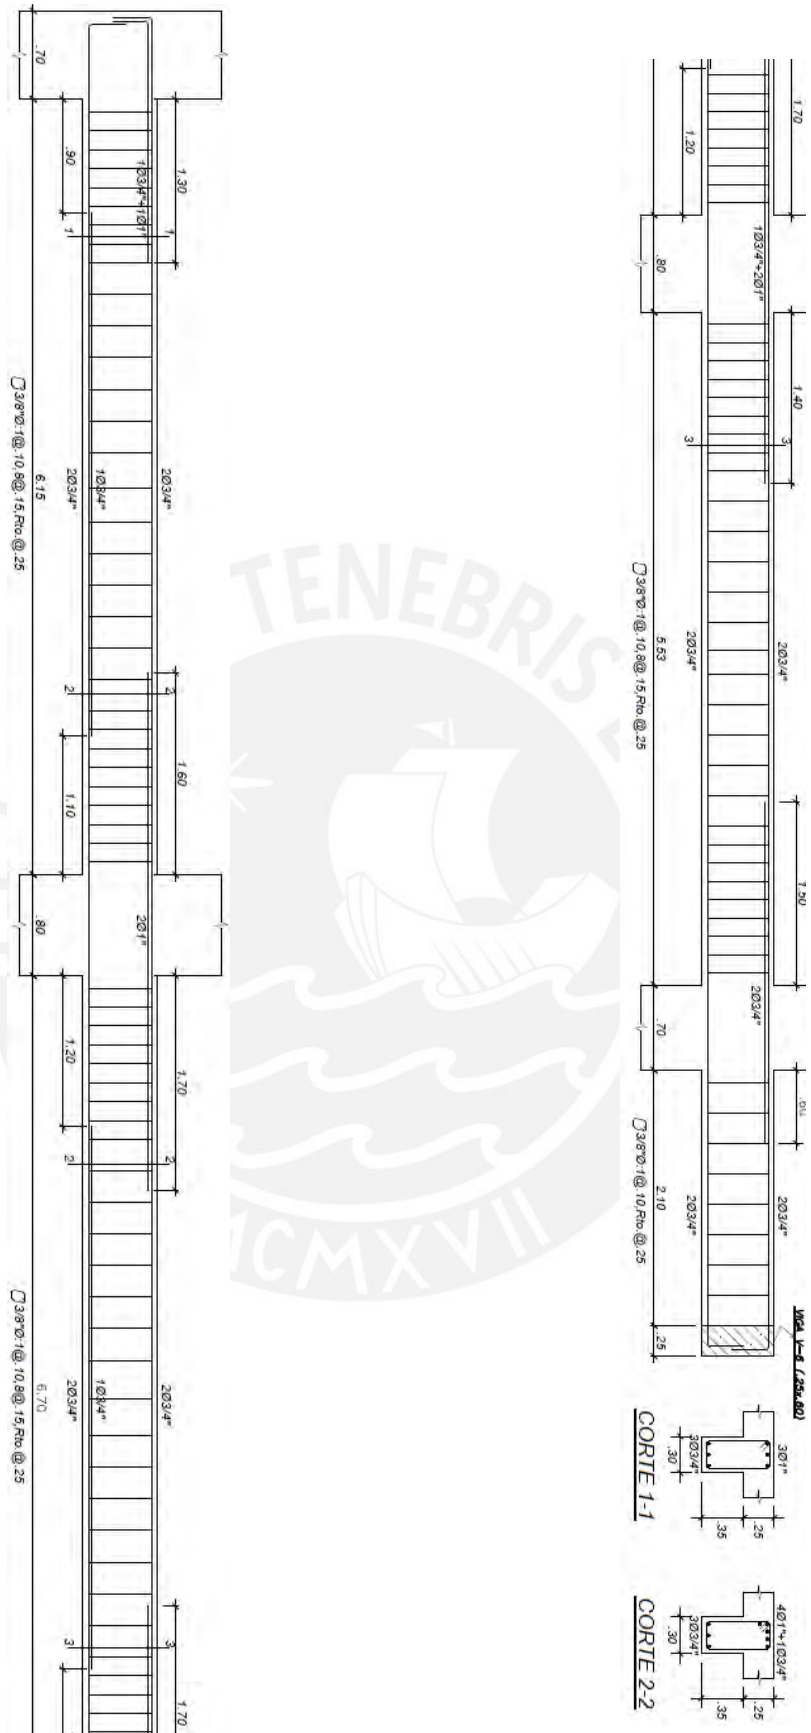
Disposición final de acero en viga V-9 (parte 1)
